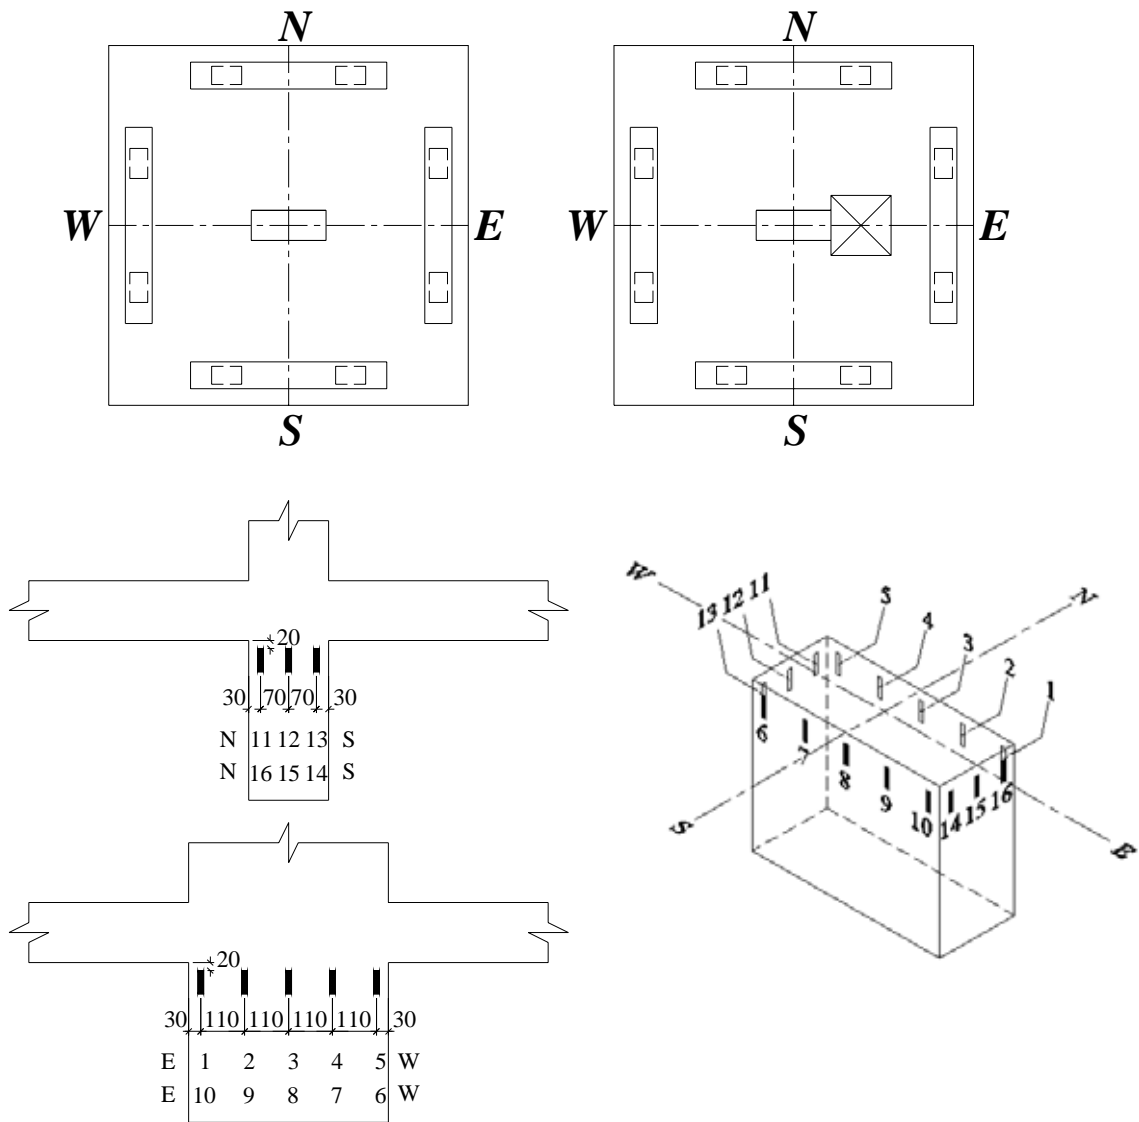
Posicionamento dos EERs do concreto nas lajes L1 a L4 (mm)
